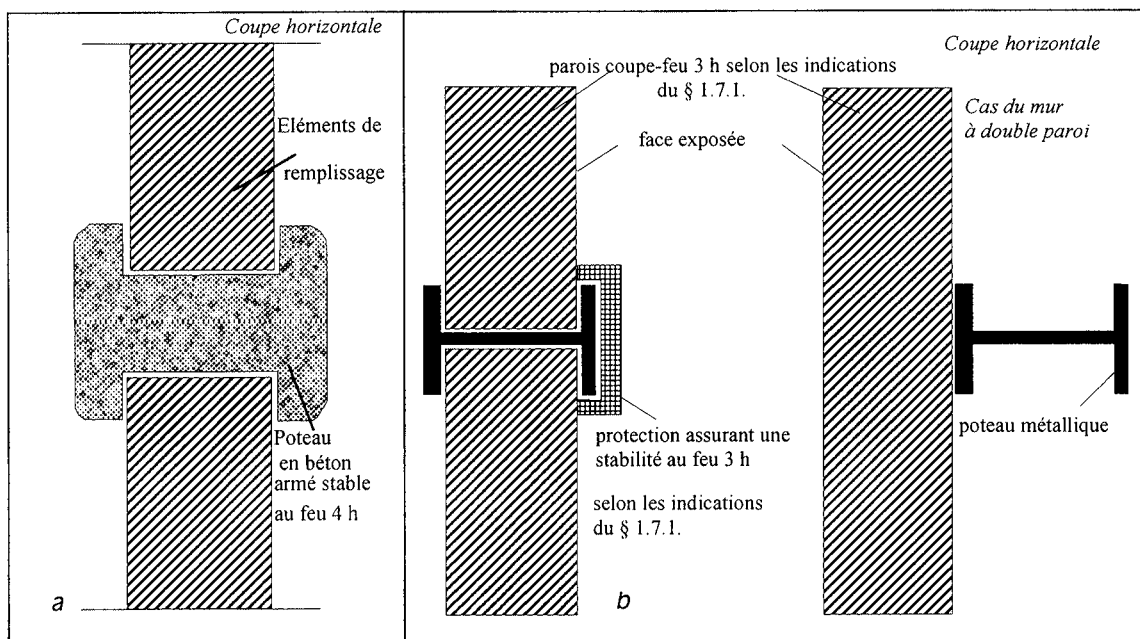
a. et 1.2.1.b : Dispositions constructives d'un mur à ossature et d'un mur à double paroi.
